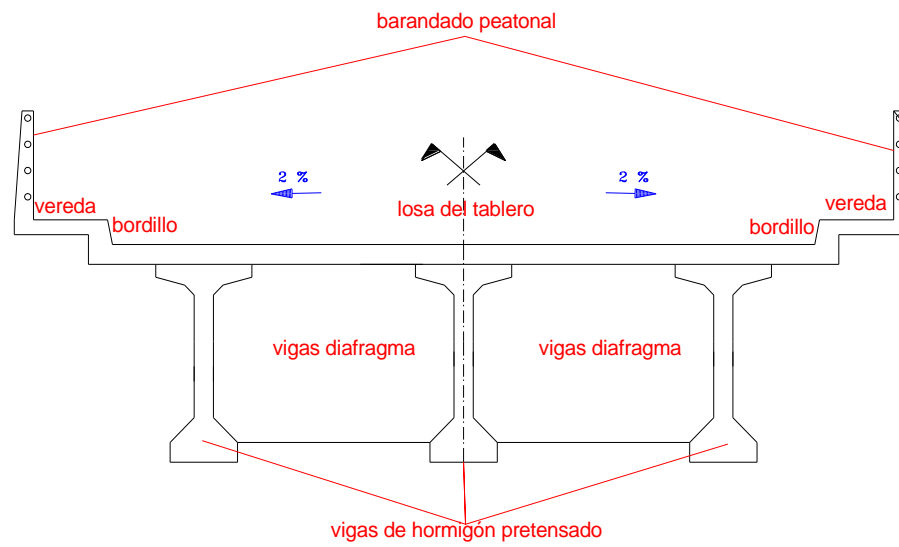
Elementos de superestructura elegida (*Fuente elaboración propia*)
